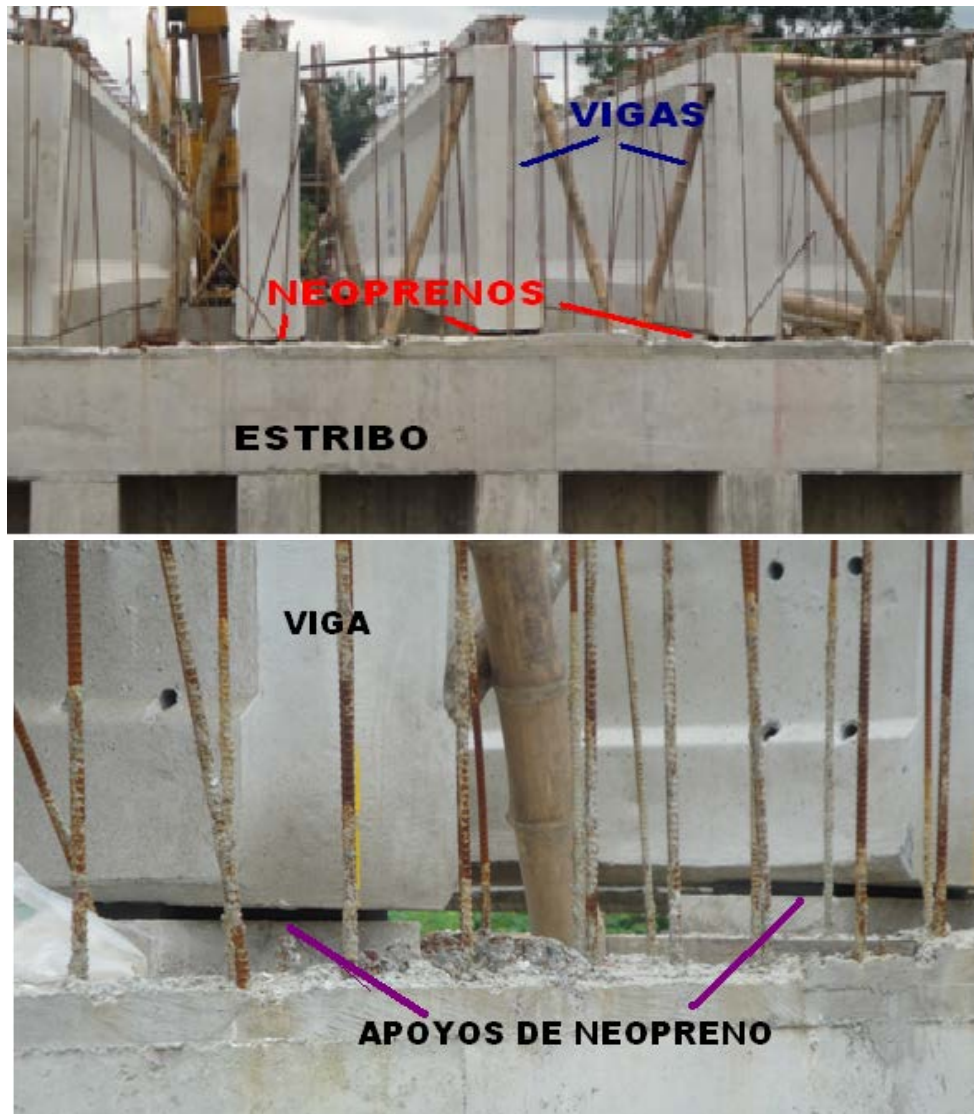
Vigas sobre Apoyos de Neopreno (PAY-PAY)
